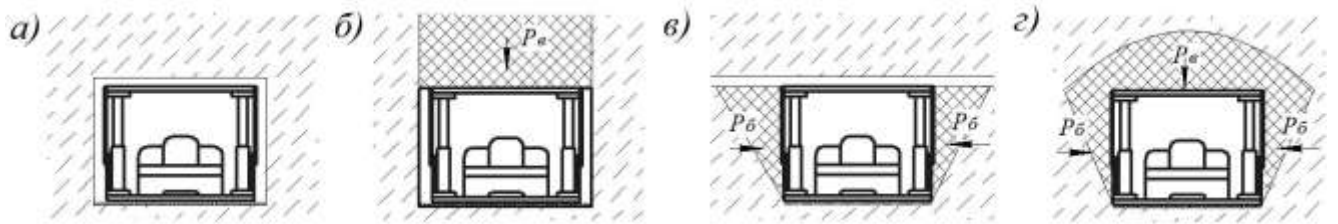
Варианты нагружения шагающей крепи проходческого комплекса: а – отсутствие внешних нагрузок на шагающую крепь комплекса; б – нагружение со стороны кровли выработки; в – нагружение со стороны боков выработки; г – нагружение со стороны кровли и боков выработки
